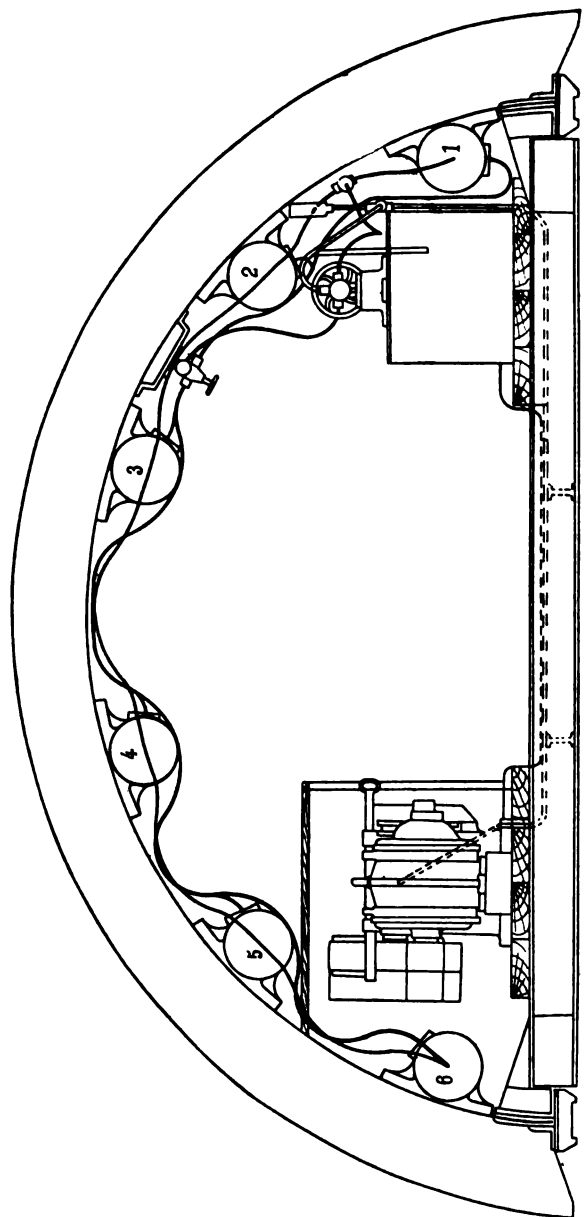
Coupe transversale du bouclier du Miniistère.
